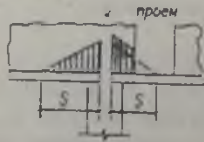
Эпюра распределения давления в кладке висячих стен при наличии проема
